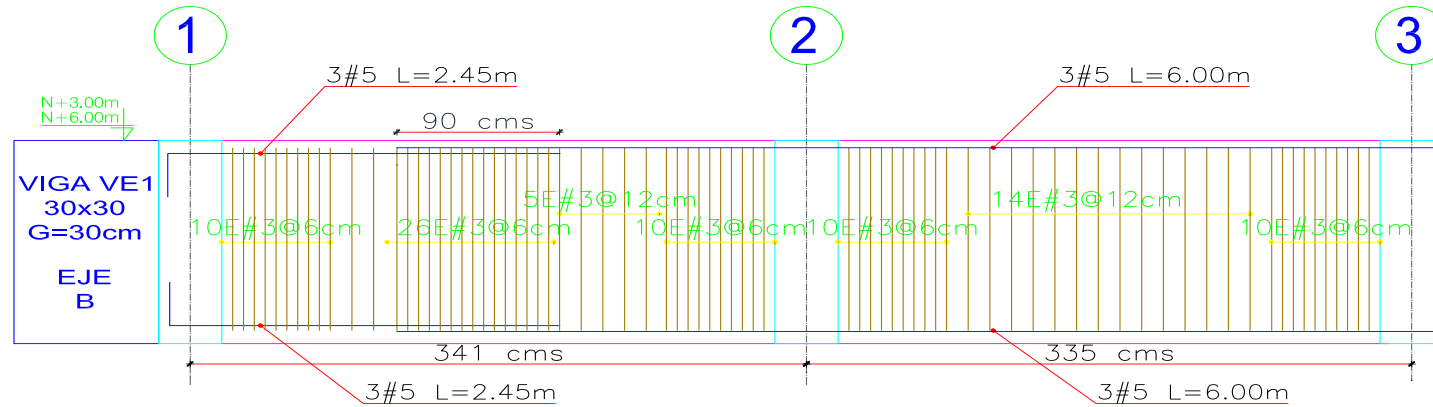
DESPIECE VIGA DE ENTREPISO VE1 EJE B N+3,00m Y +6,00m.
